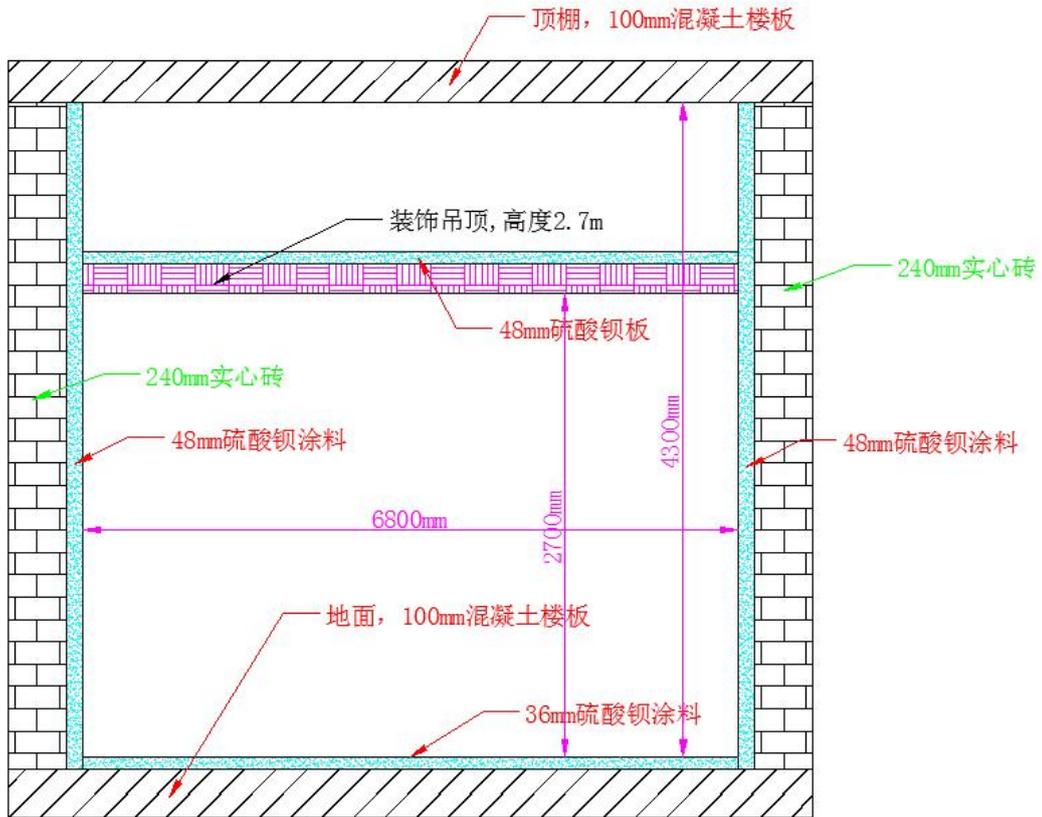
四周墙体、地面、顶棚防护工艺示意剖面图
